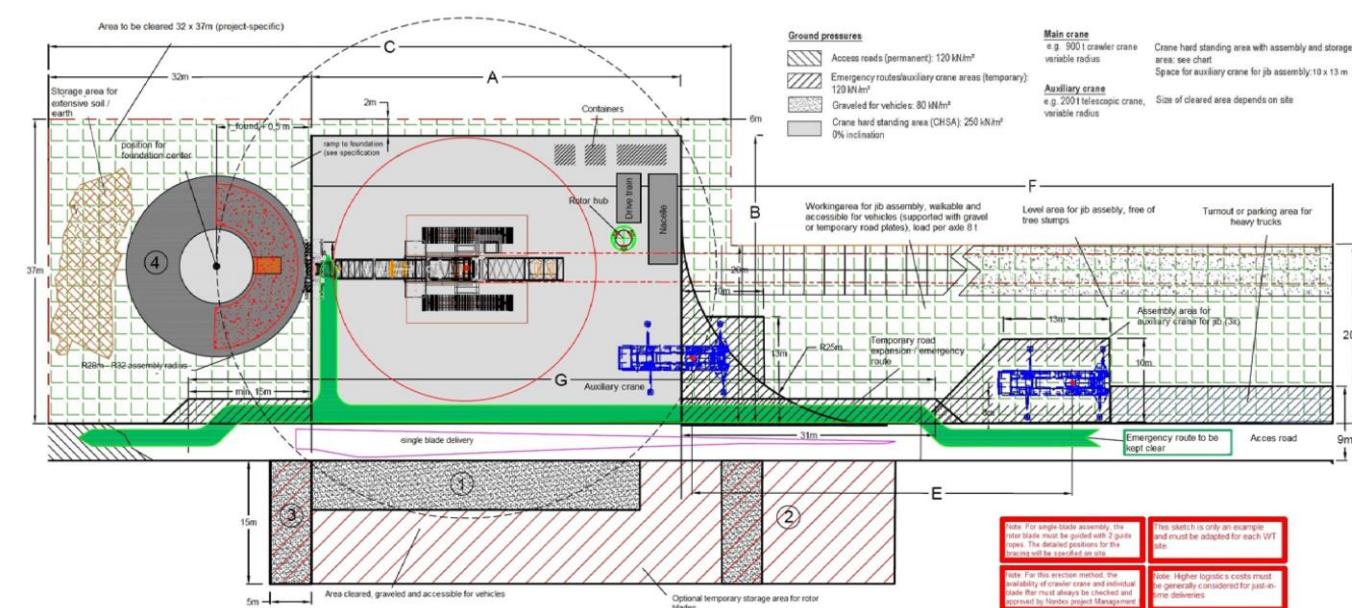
Plateforme de montage avec grue optimisée pour les zones sur les terrains ouverts (assemblage à une seule pale) pour les éoliennes d'une hauteur de moyeu jusqu'à 170m
